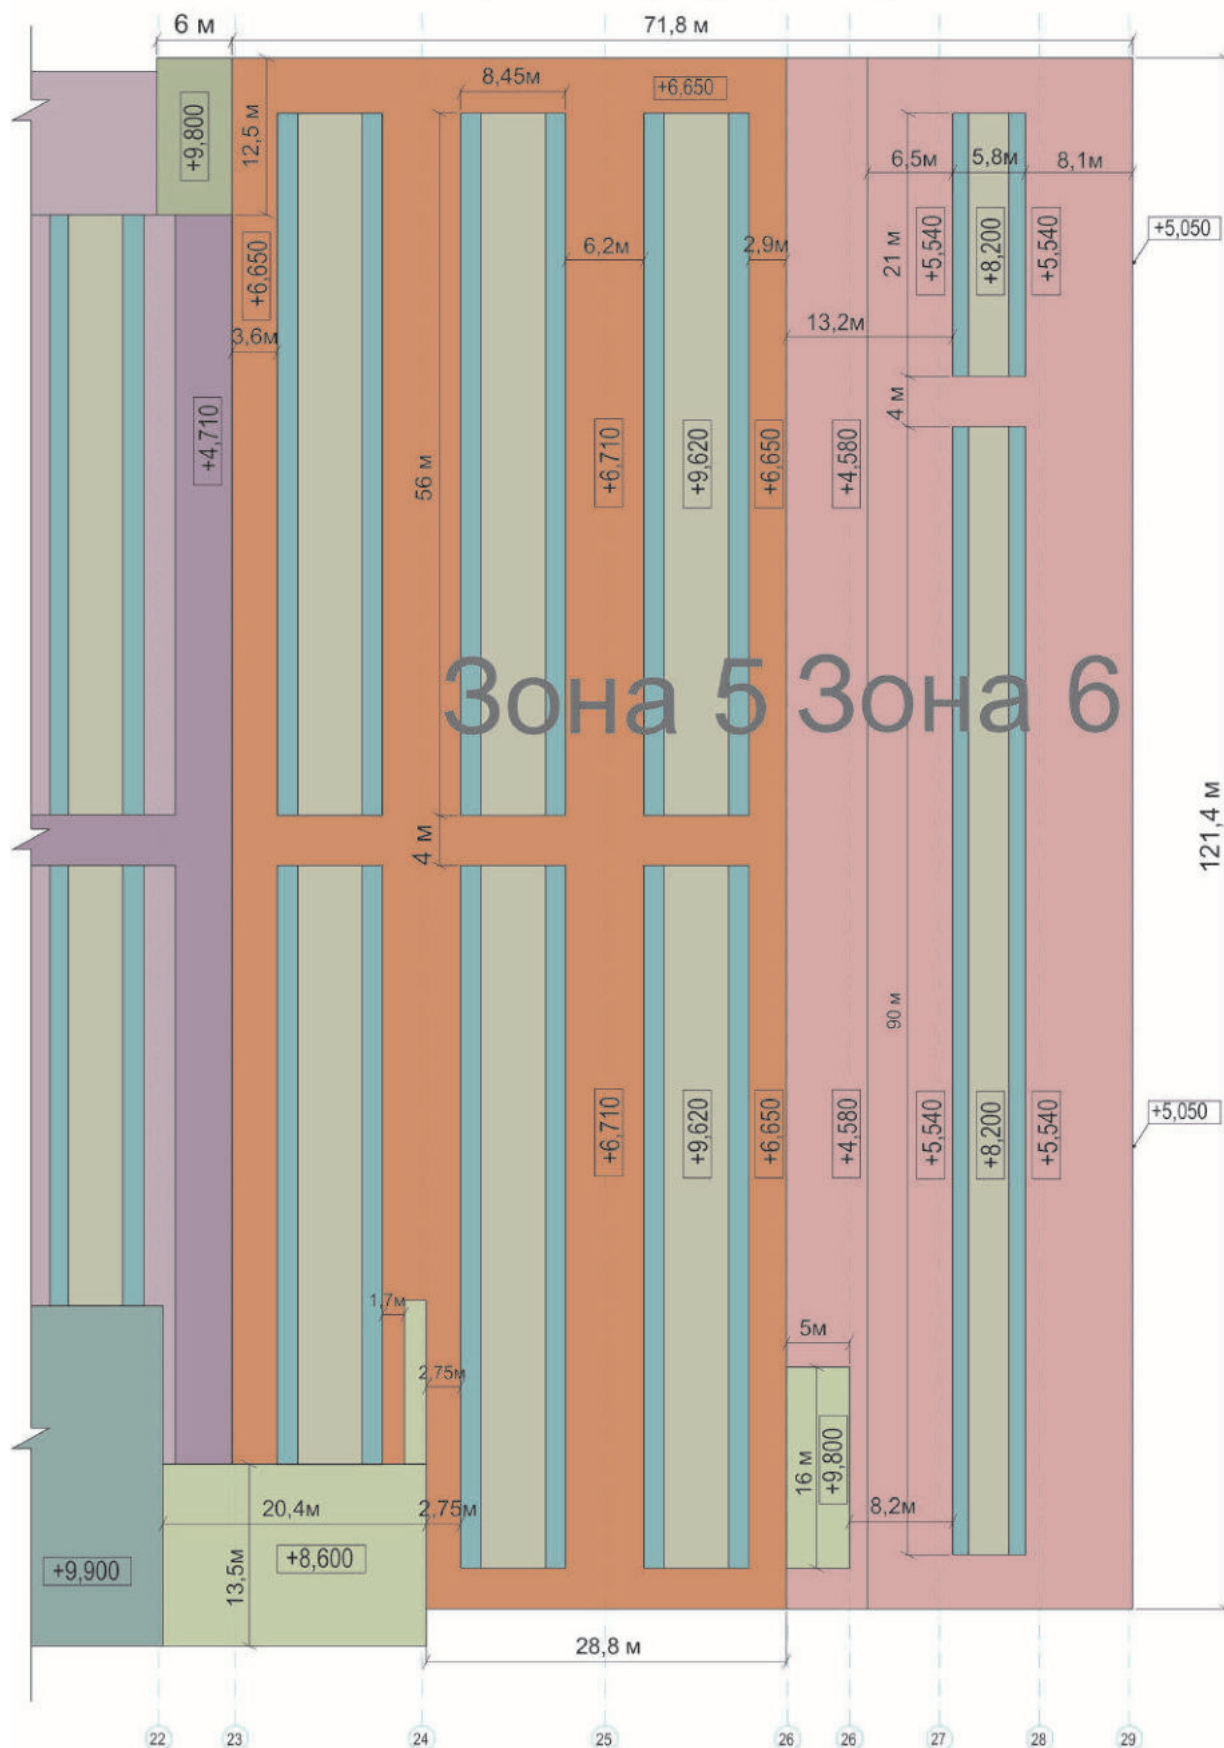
Фрагмент плана покрытия корпуса №5. 1-ый вариант покрытия
